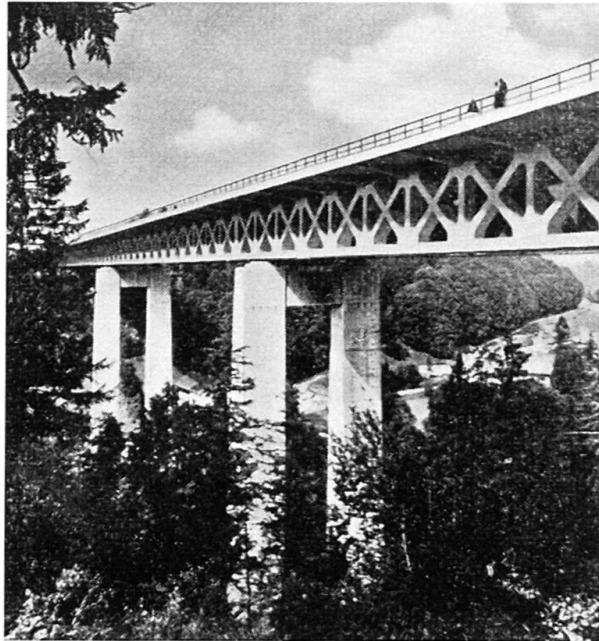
Mangfallbrücke (Spannbetonbrücke).
